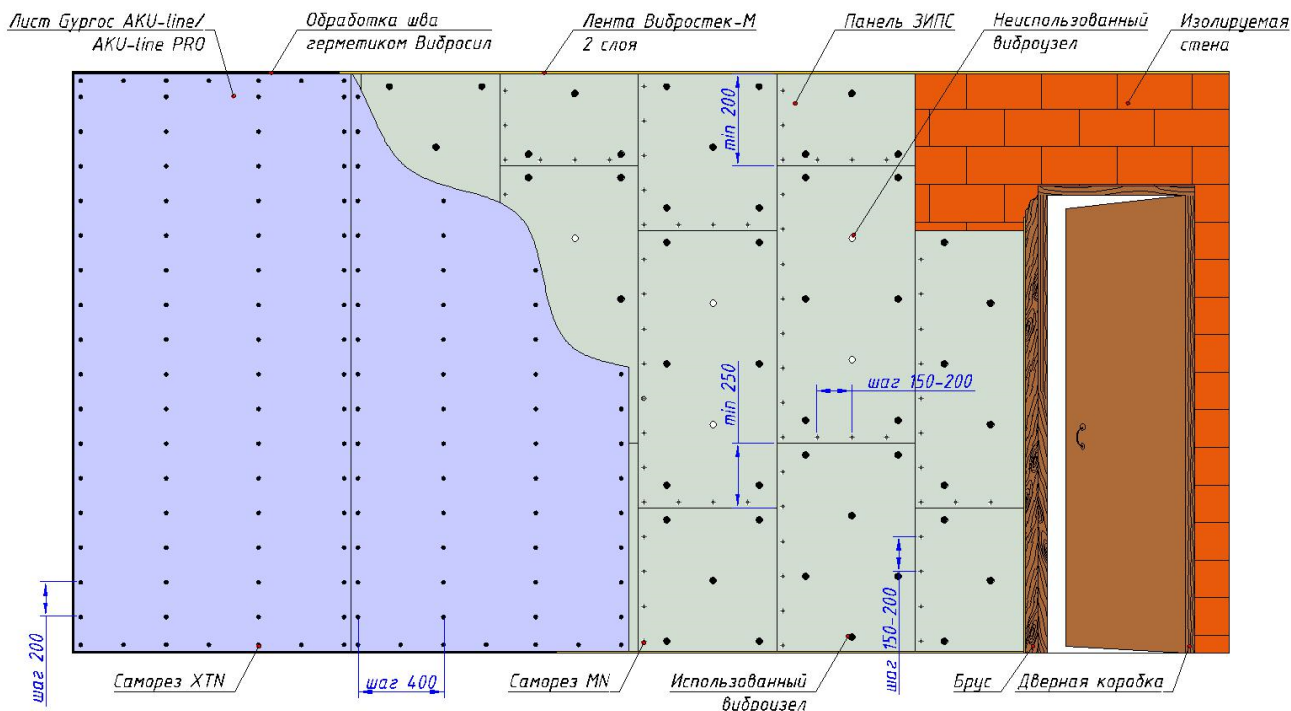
Схема монтажа бескаркасной системы ЗИПС.
